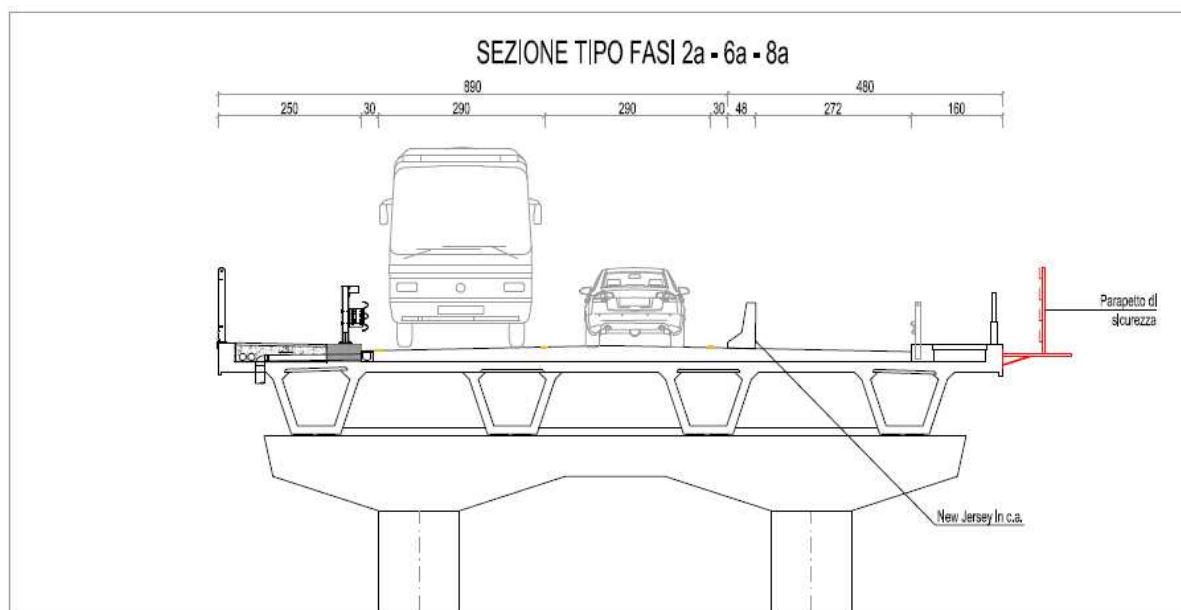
Individuazione dell'area di cantiere, relativamente alla fase 2 a, sulla base dell'ingombro del mezzo di cantiere e del New Jersey in calcestruzzo armato
